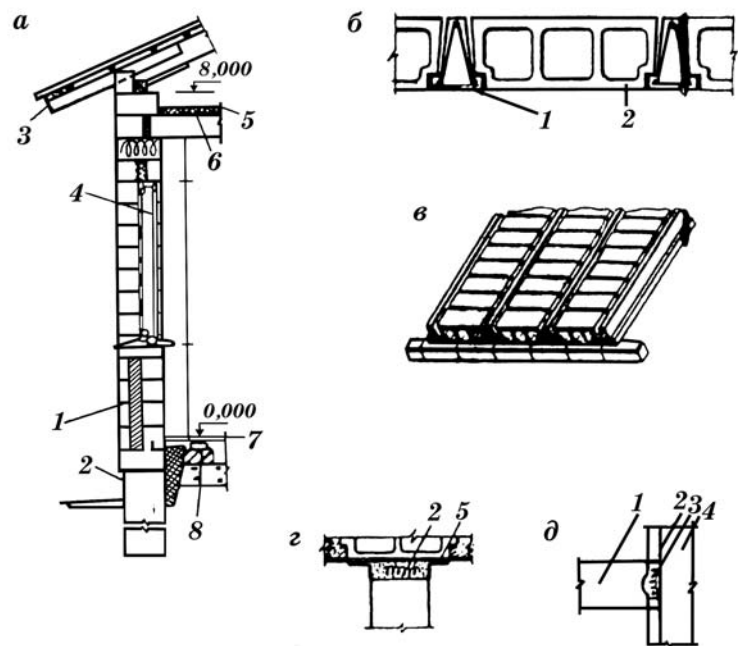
Основные конструктивные узлы и детали дома: а – разрез стены: 1 – камни; 2 – фундамент; 3 – кровля; 4 – окно; 5 – перекрытие; 6 – утеплитель; 7 – пол; 8 – гидроизоляция; б – перекрытие: 1 – балка; 2 – камень для перекрытий; в – фрагмент перекрытия; г – узел опирания камня перекрытия на стойку; д – узел примыкания перегородок к стене: 1 – перегородочный камень пустотелый; 2 – конопатка; 3 – раствор; 4 – стена.
